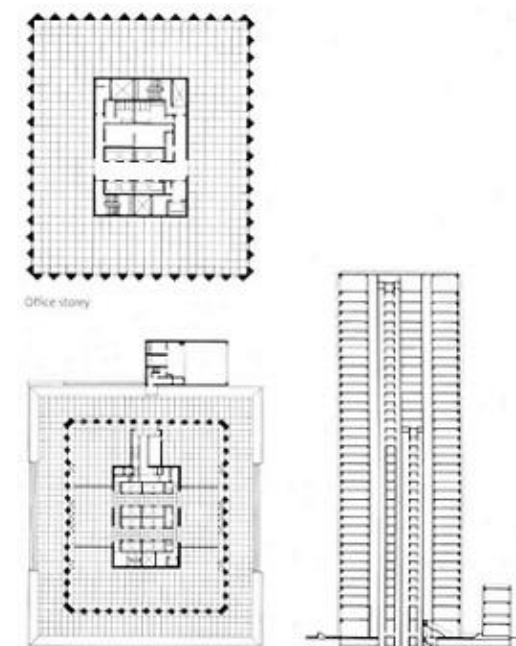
CBS Building, Arquitecto Eero Saarinen, New York, 1965
